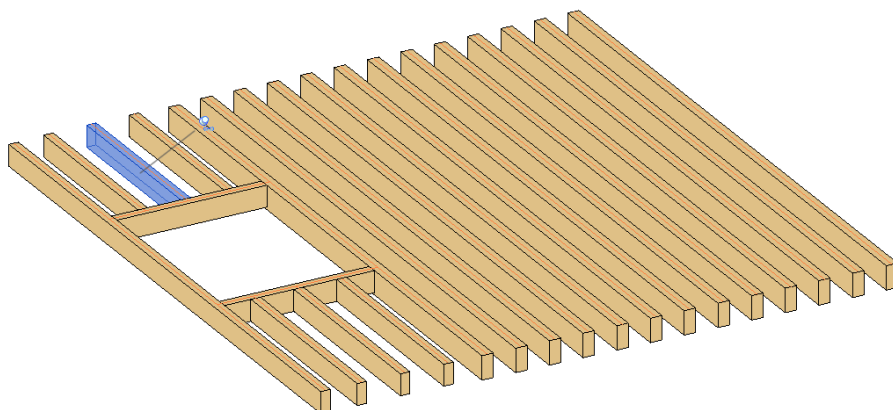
Modelação em Revit do novo pavimento (vigamento) da divisão Norte, lado nascente.
